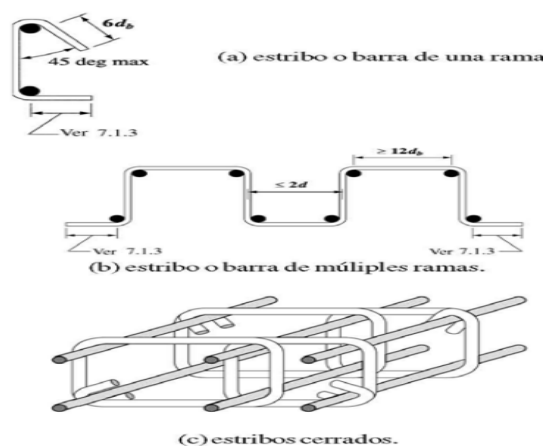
Refuerzo para cortante en losas, estribo de una o varias ramas
